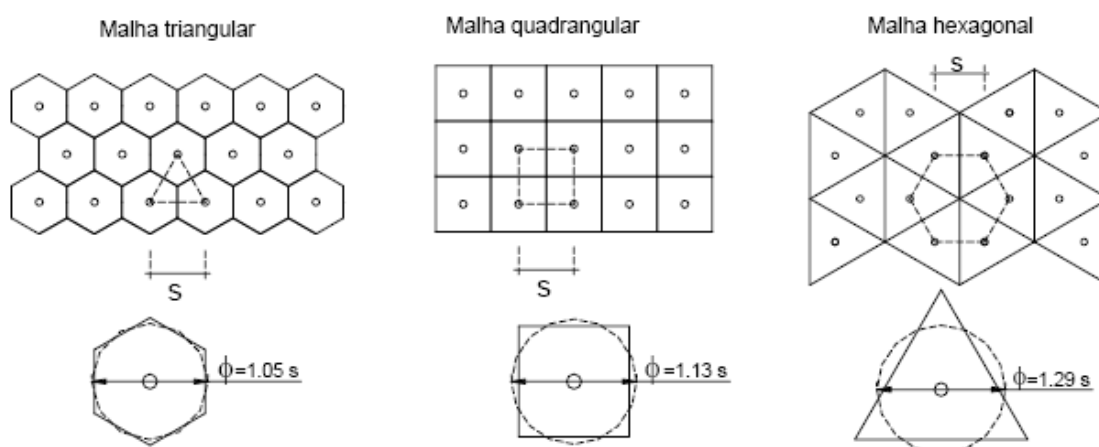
Diferentes distribuições em planta de drenos verticais
